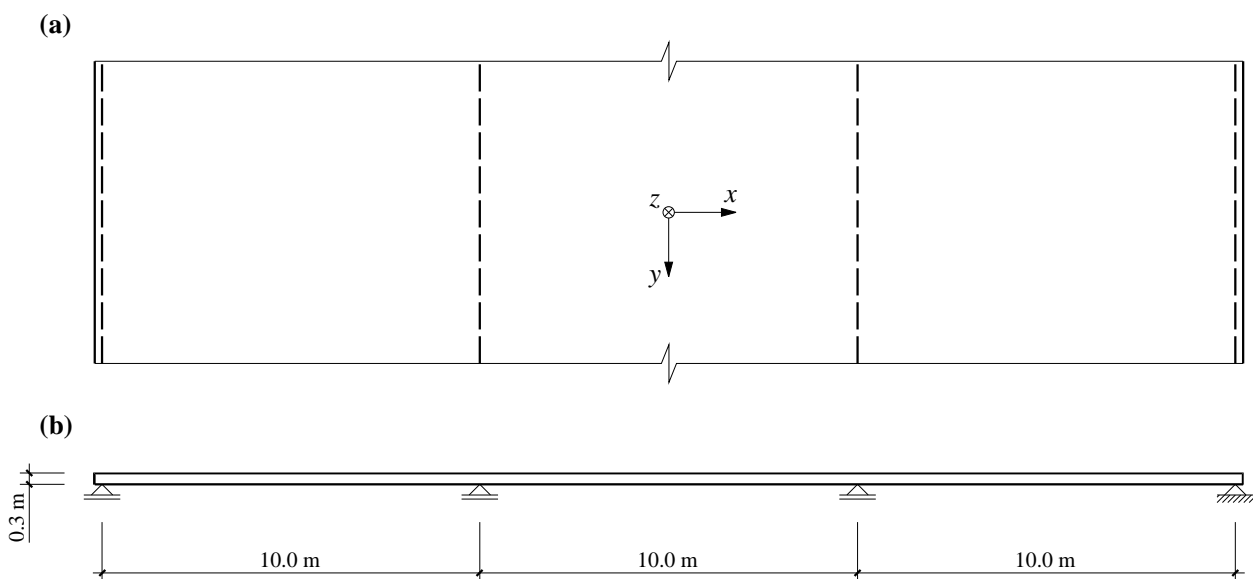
(a) Aufriss, (b) Querschnitt der in Aufgabe 4 behandelten Stahlbetonplatte.
